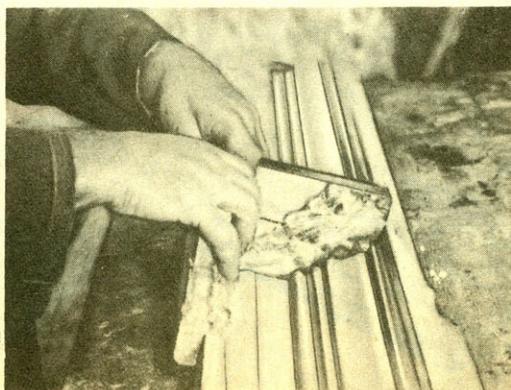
Шаблон для изготовления розеток в сборе (Б — центрирующий гвоздь).
